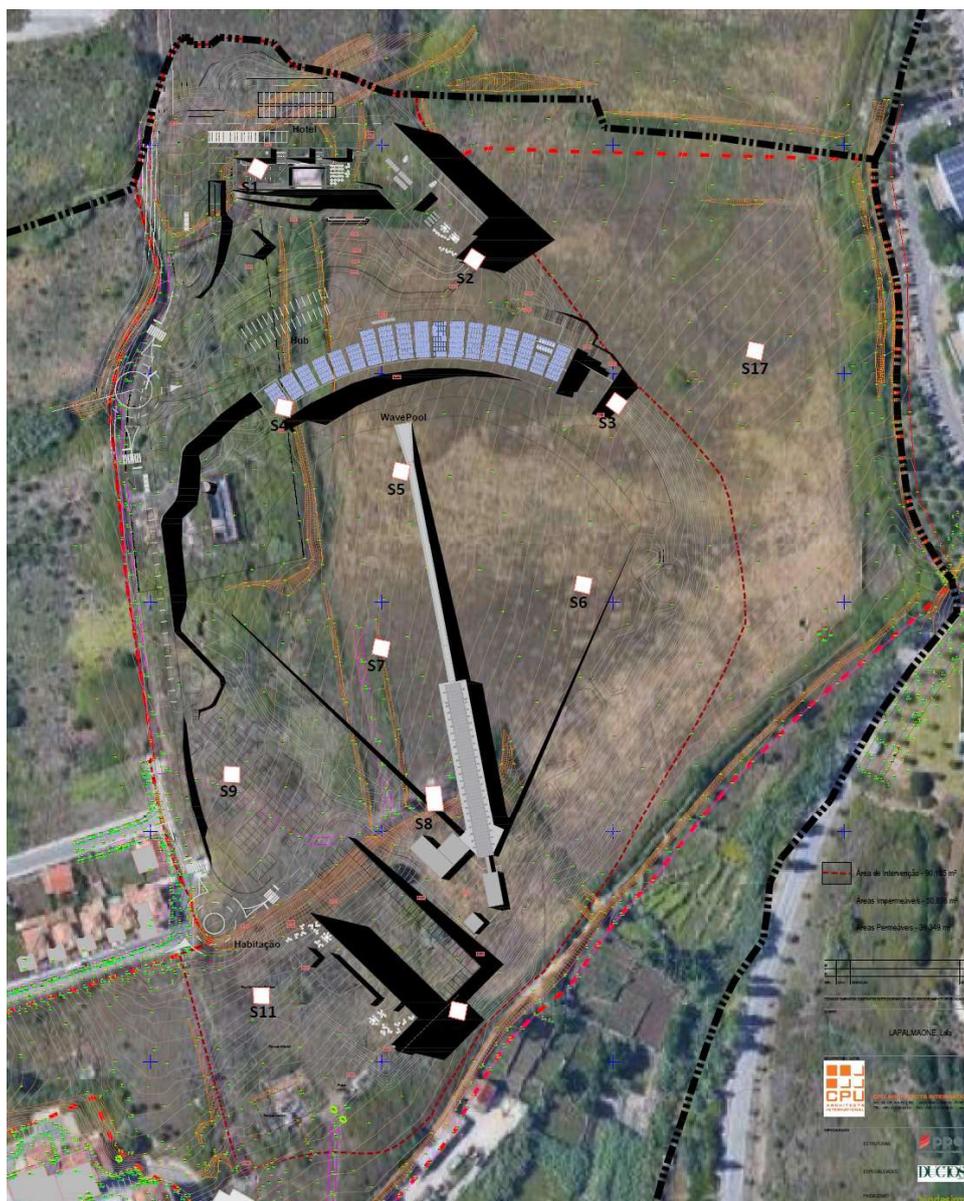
Planta de intenções do PLano com implantação das sondagens arqueológicas realizadas.
